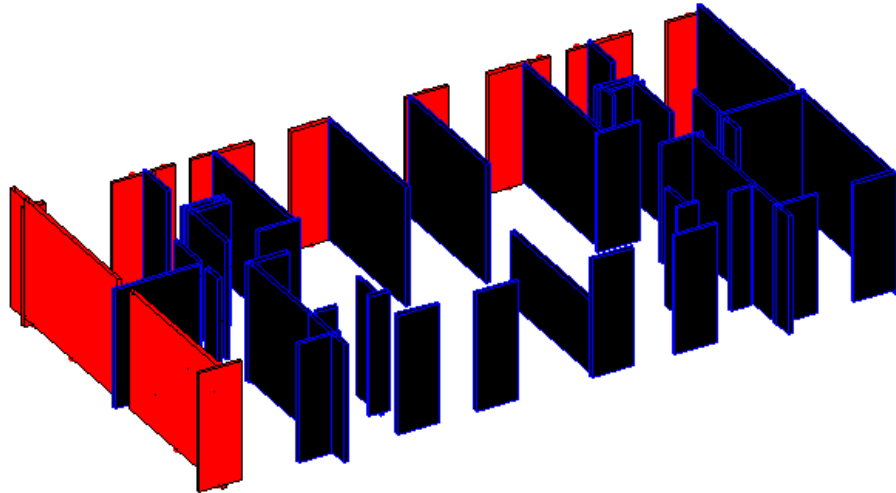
Muros de mampostería entre los niveles de cimentación y 1er Entrepiso.
